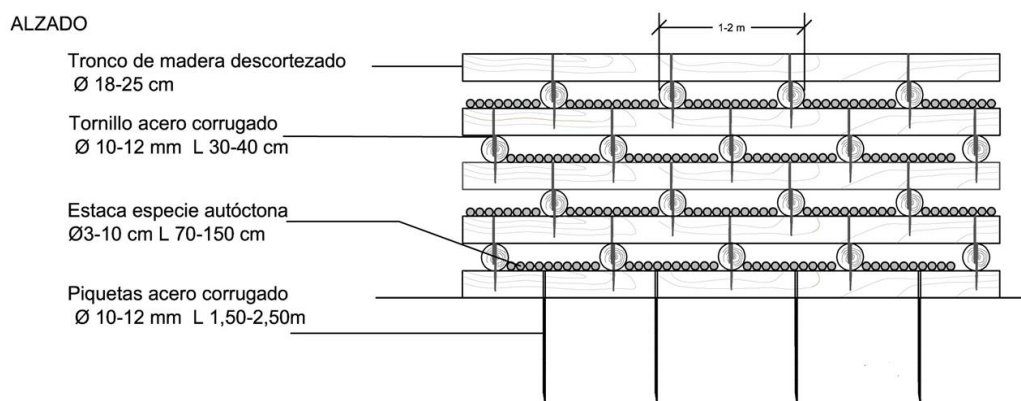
Esquema de alzado de la estructura de entramado vivo de madera. Fuente: (NTJ, 2017)
